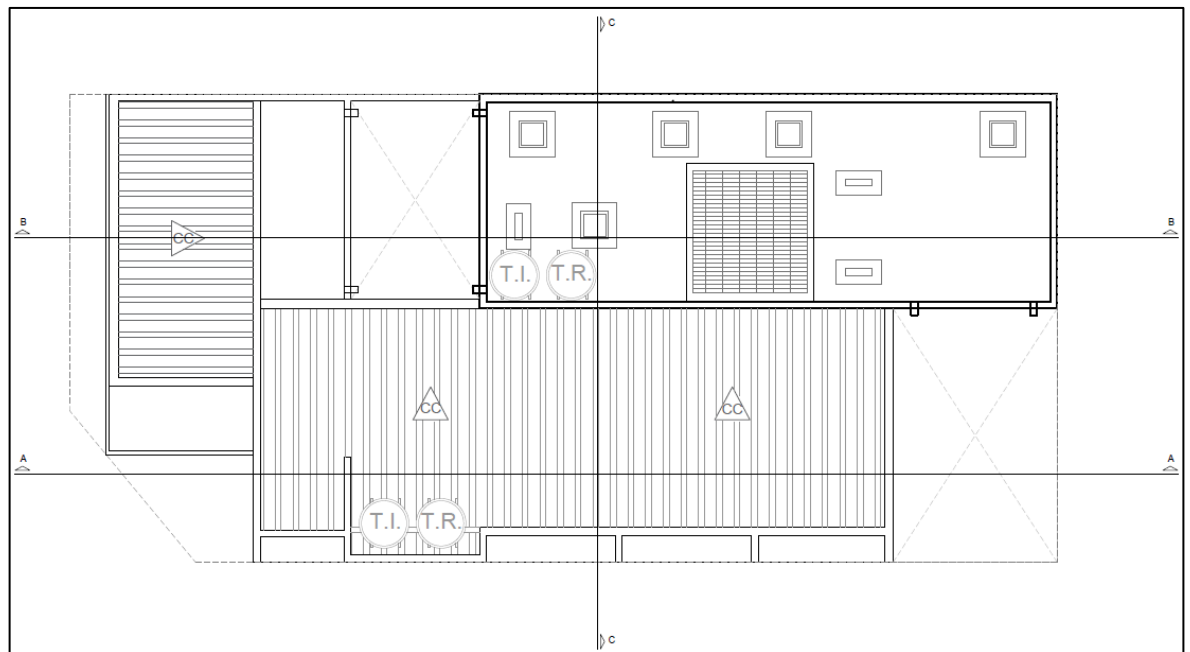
Plano de Layout de edificio – Cubierta y Losa de Tanques
